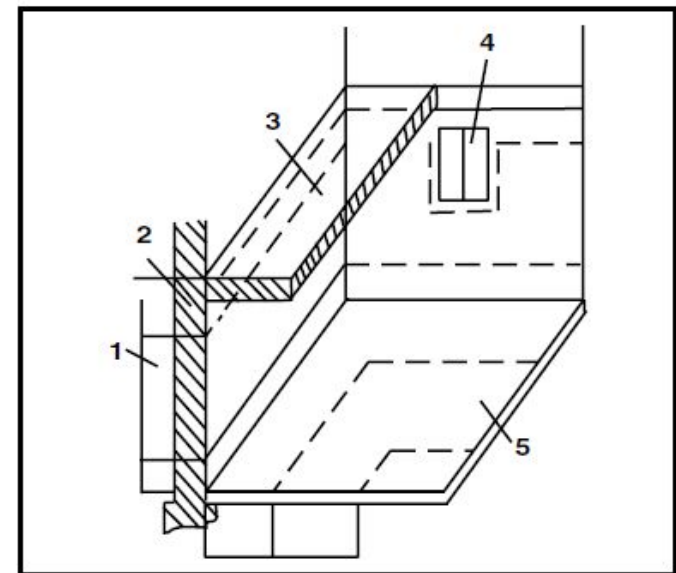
Разбивка заглубленных частей наружных стен и пола углового 4 подвального помещения на I - IV расчетные зоны 1 - земля; 2 - наружная стена; 3 - перекрытие; 4 - окно; 5 - пол.
